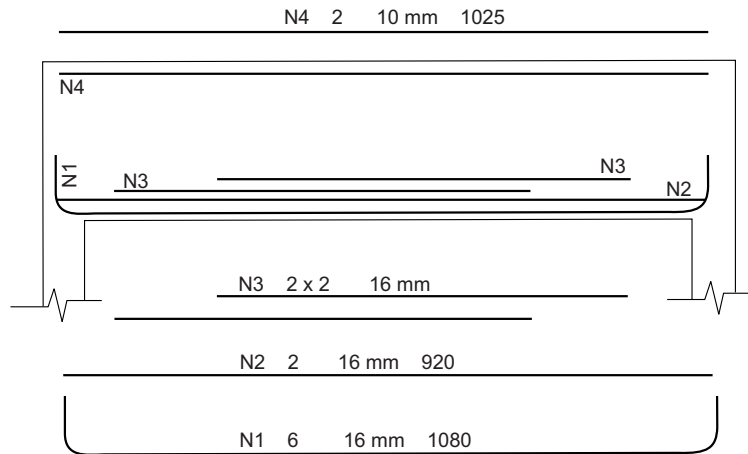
Desenho esquemático do detalhamento da armadura principal no qual estão omitidas todas as outras armaduras da viga (costelas, cisalhamento, etc.).
